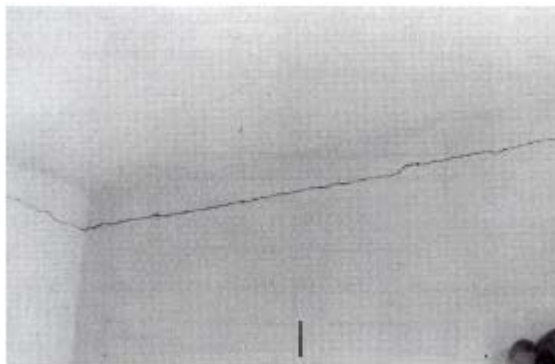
fissura horizontal no topo da parede por movimentação térmica da laje de cobertura (THOMAZ, 1989)
